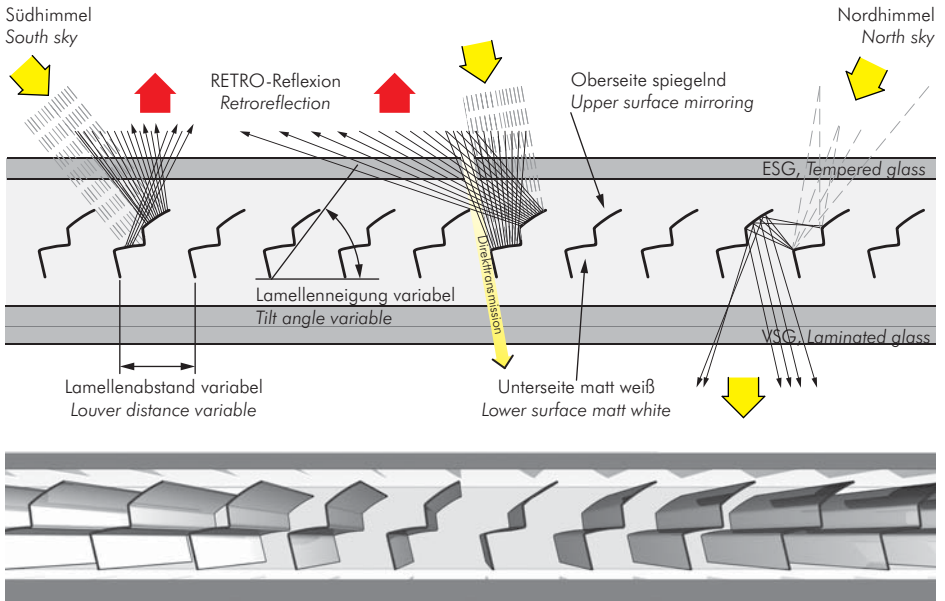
RETROLuxTherm im Dach mit Blick nach Norden
